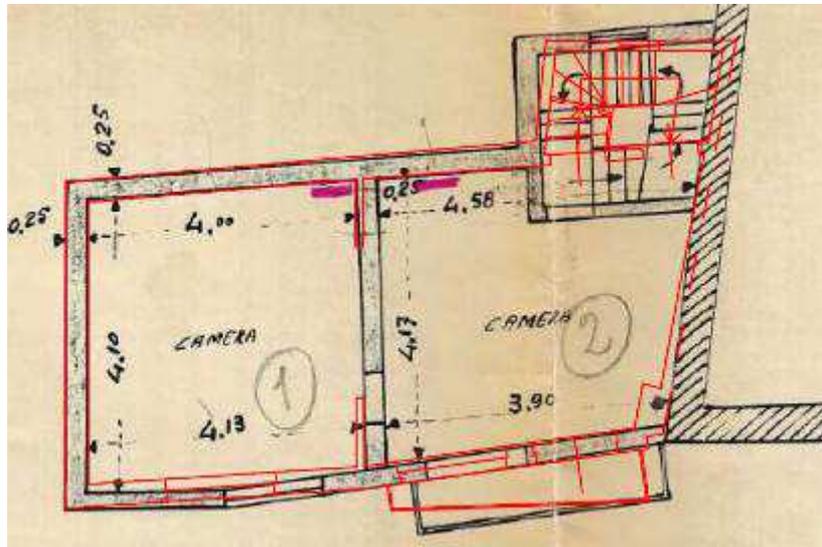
Comparazione stato attuale – stato rilevato (p.1).
